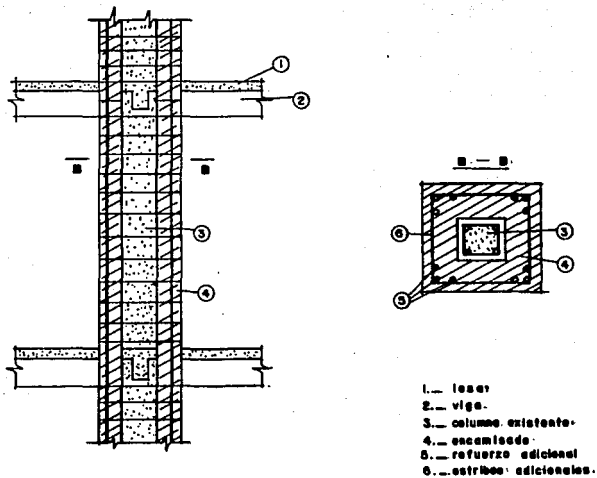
Encamisado de columnas con concreto reforzado (Ref.15)
